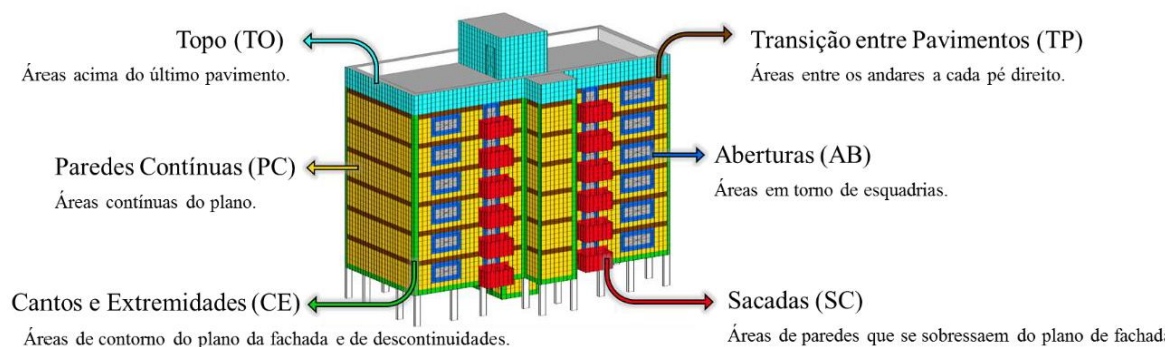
Delimitação das zonas constituintes da fachada (PINHEIRO, 2017 e Adaptado por SOUZA, 2019)
